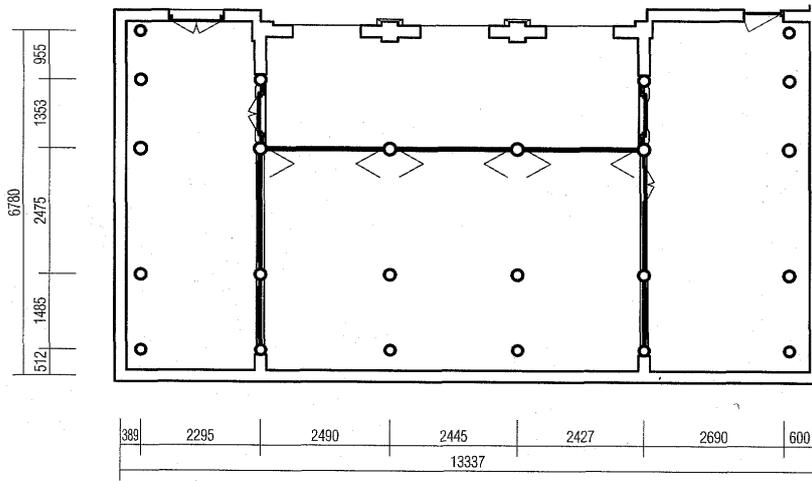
Ha Van Vinh邸 主屋 平面図 1:150
